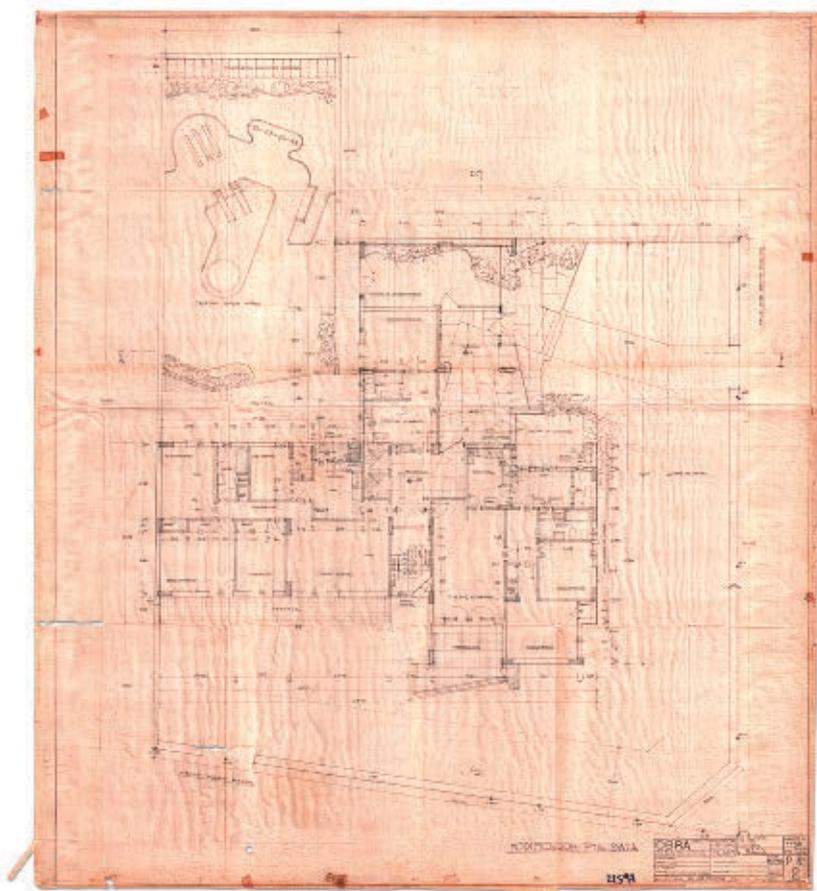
EDIFICIO CRUZ DEL SUR. PLANTA BAJA.
